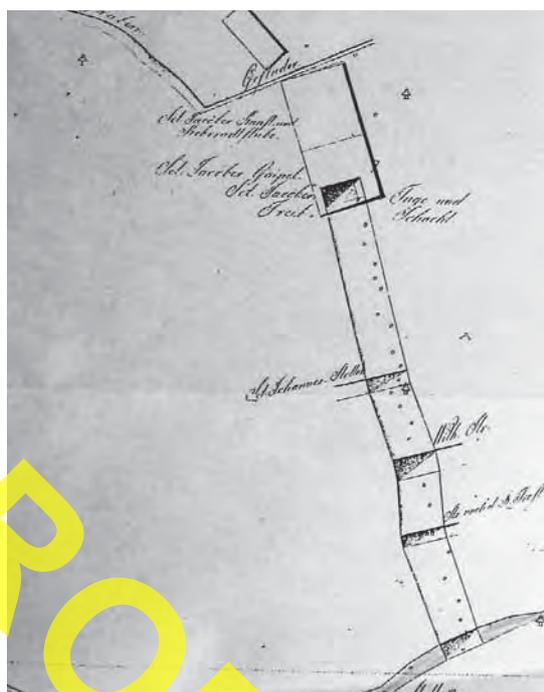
Grundriss des für Revisionszwecke weiterhin genutzten Tagesschachtes mit einem Kehrroad (MEINE 1800).
